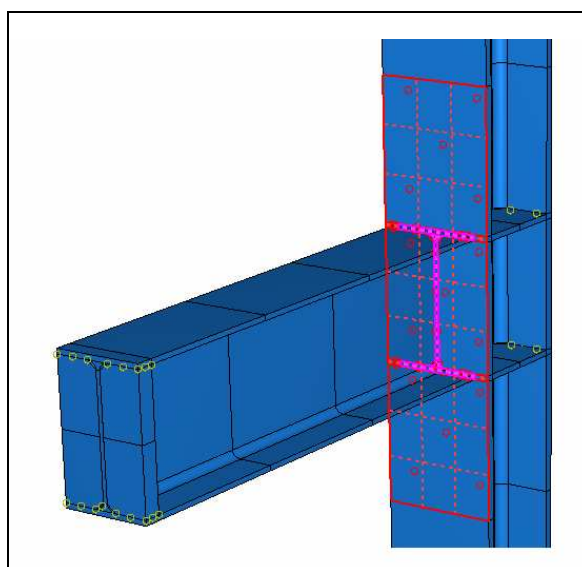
Ligação rígida viga-coluna do modelo WW-S1.
